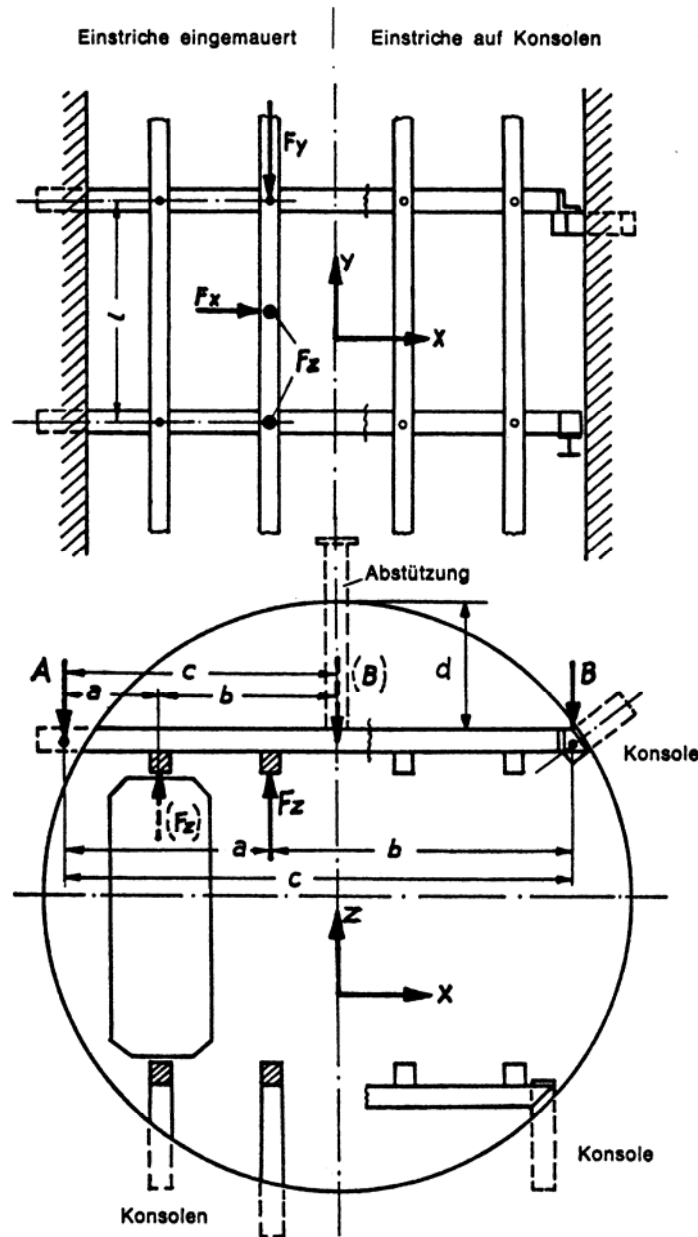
Schnittzeichnungen durch Fahrtrum, mit eingemauerten Einstrichen, mit Einstrichen auf Konsolen und mit Beanspruchungskräften.
